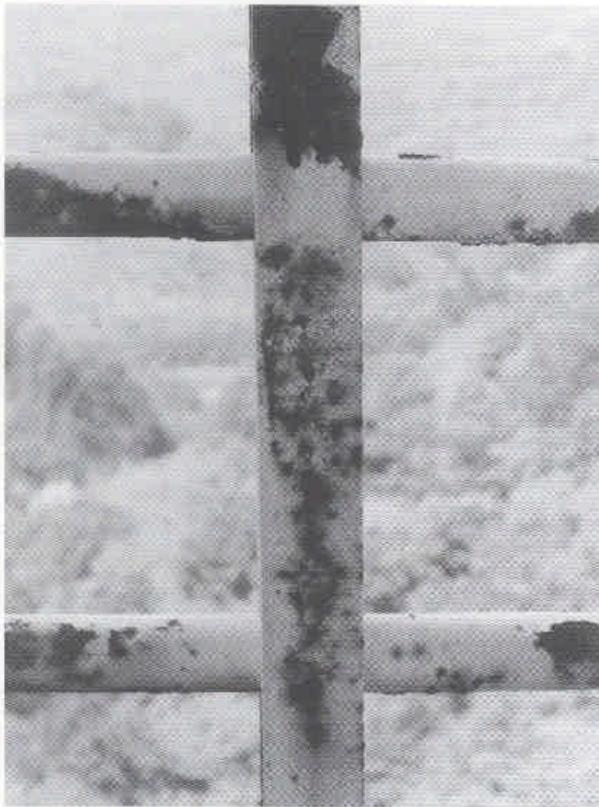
Vista particolare dell'aspetto iniziale delle strutture
